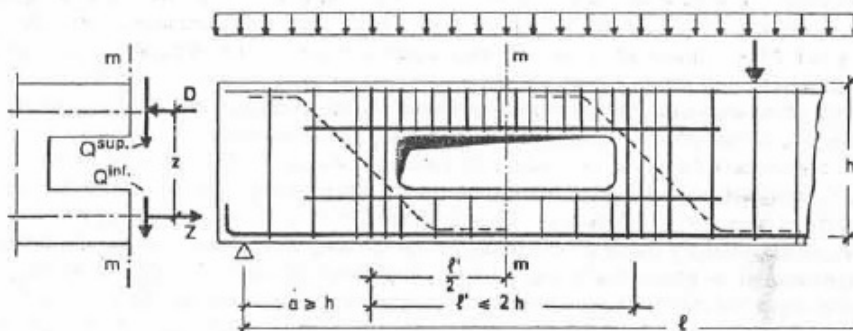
Armadura de almas con aberturas rectangulares.
